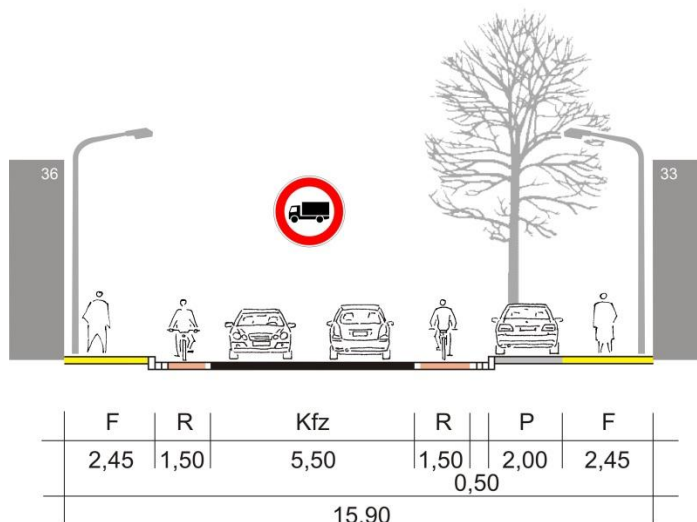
Gestaltungsvorschlag Sutthausen Straße – Variante 2
